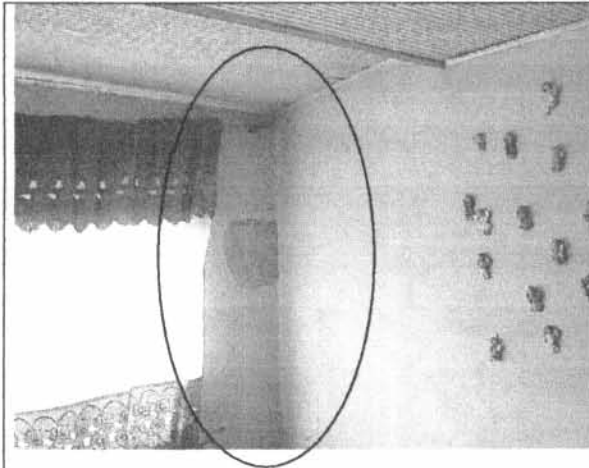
Deterioro progresivo de la edificación y Fisuras en los muros de la sala – Fachada-Piso 3
